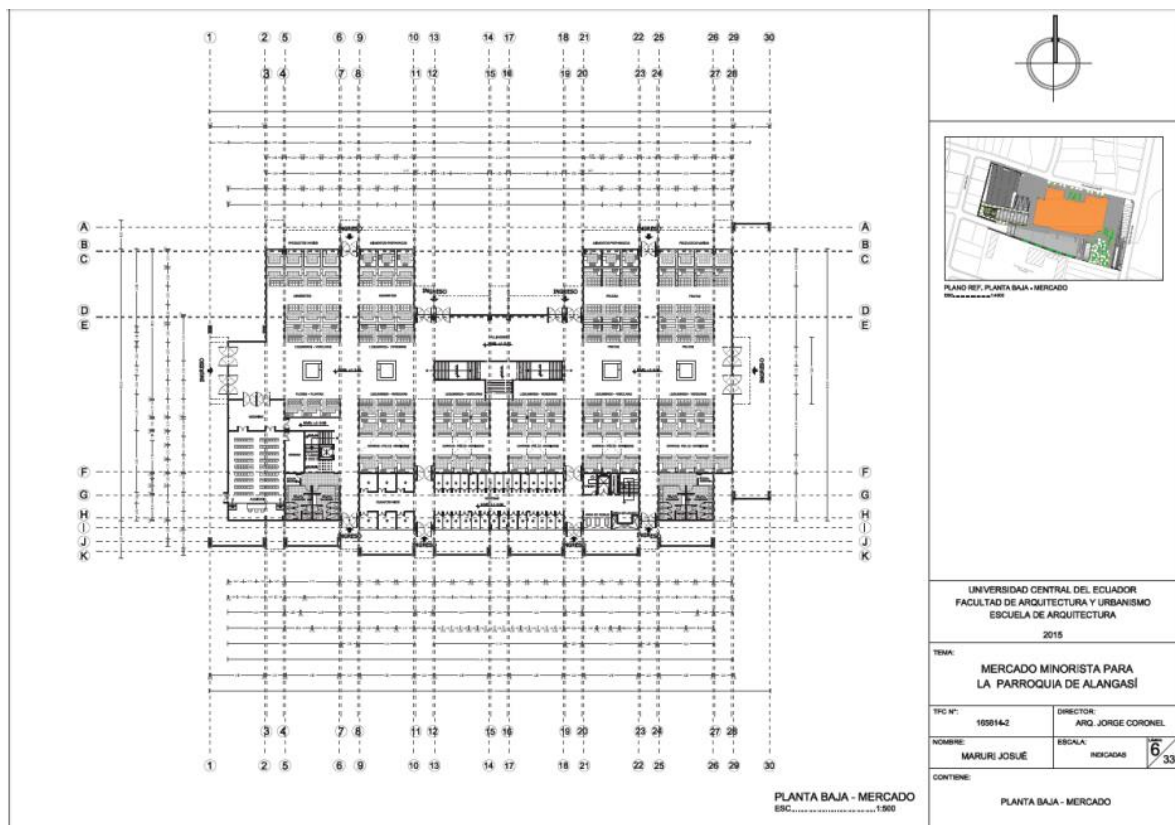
; PLANTA BAJA; Fuente: Josué Maruri Lovato
